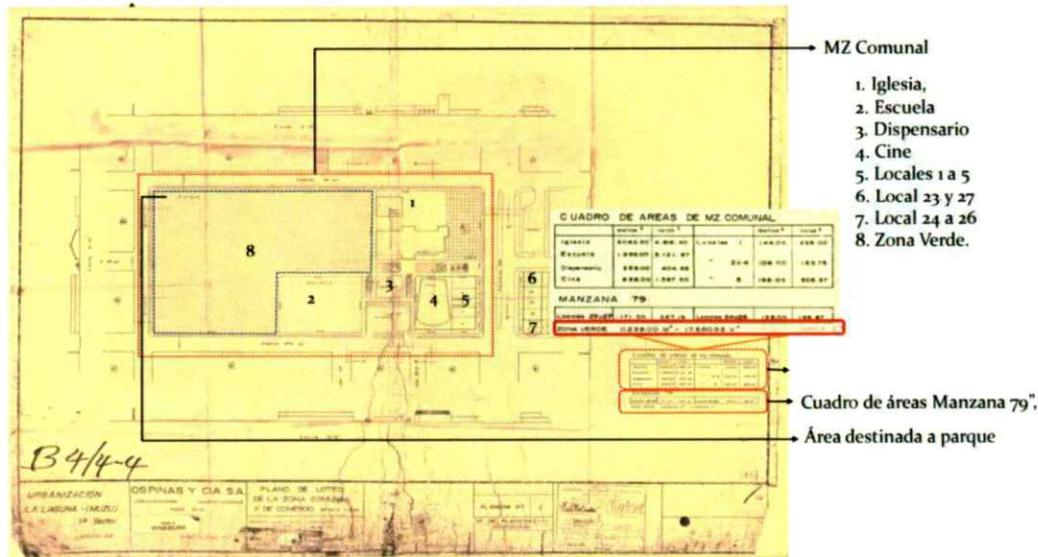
Análisis de áreas aprendidas por el DADEP en el ámbito de la Urbanización “La Laguna” (Muzú). en el marco del Plano de Mojones y zonas de cesiones Decreto 468 de 1960. Plancha 1/2 _ Plano B4/2-4 Urbanización “La Laguna” (Muzú) 1º Sector
